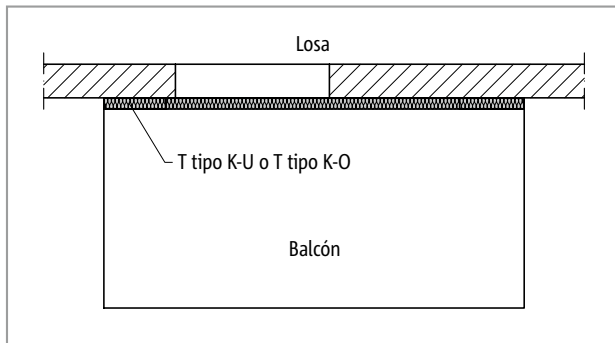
Schöck Isokorb® T tipo K-U o T tipo K-O: Balcón en voladizo
